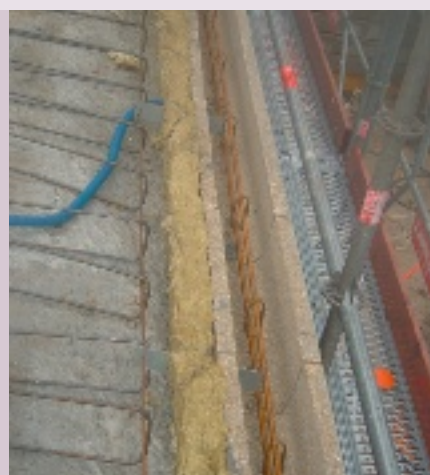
Chaînage béton armé vu de dessus, avant le coulage de la dalle en béton
